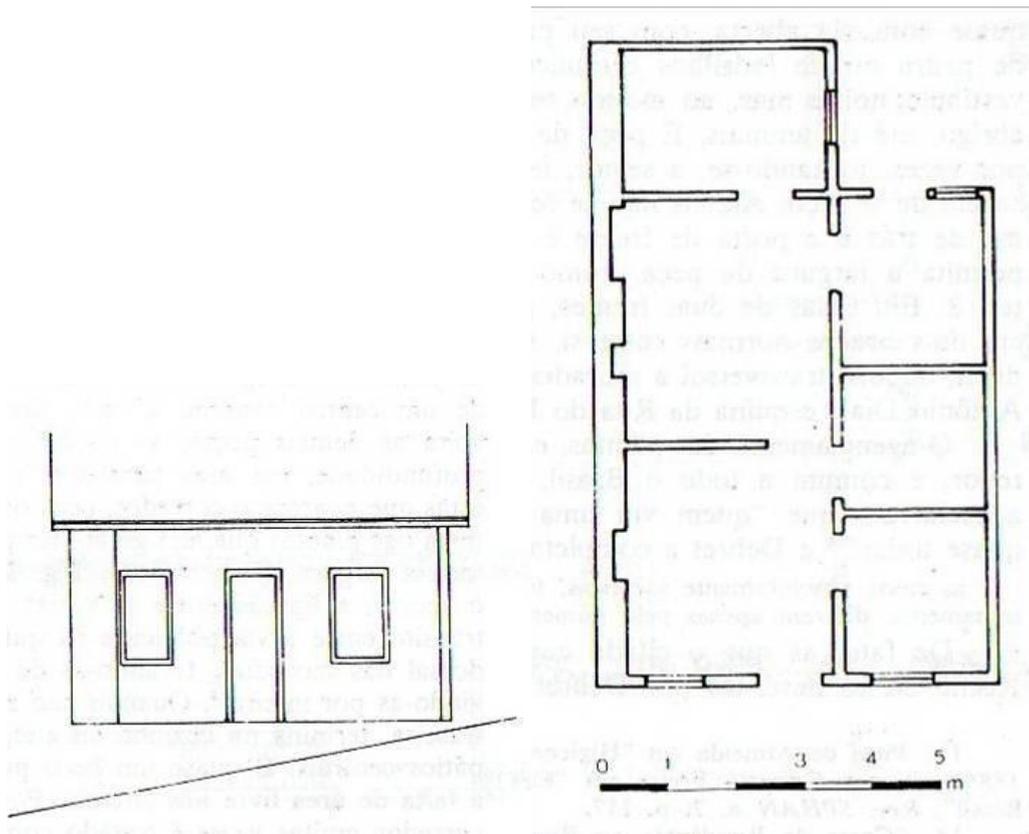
Fachada e planta baixa que exemplificam *casas urbanas térreas*.
